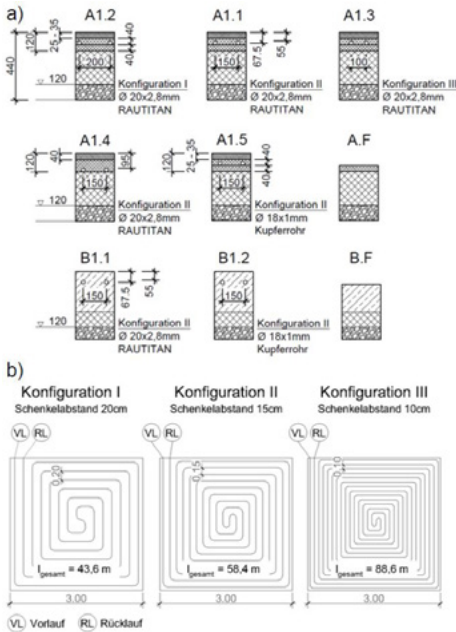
TECHNIKUM Füssen: Aufbau der temperierten Tesflächen a) Fahrbahnaufbauten mit integrierten Absorber-Rohrleitungen, b) Rohrleitungskonfigurationen im Grundriss
